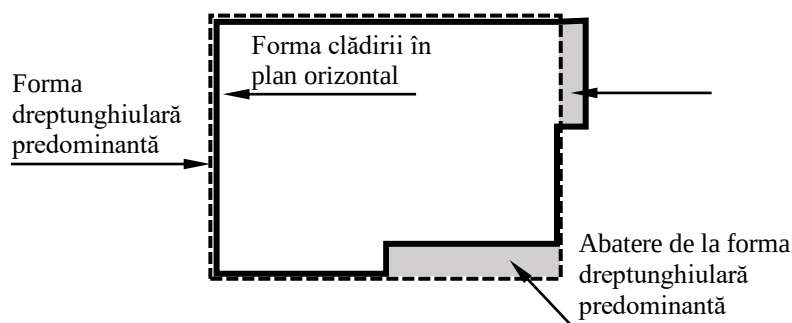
Schiță informativă privind evaluarea abaterilor de formă în plan orizontal
